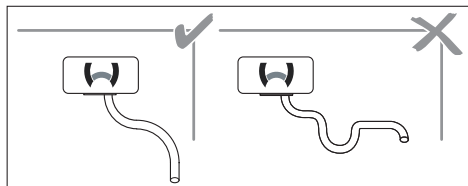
Не допускайте образования сифона (опасность скопления конденсата)
